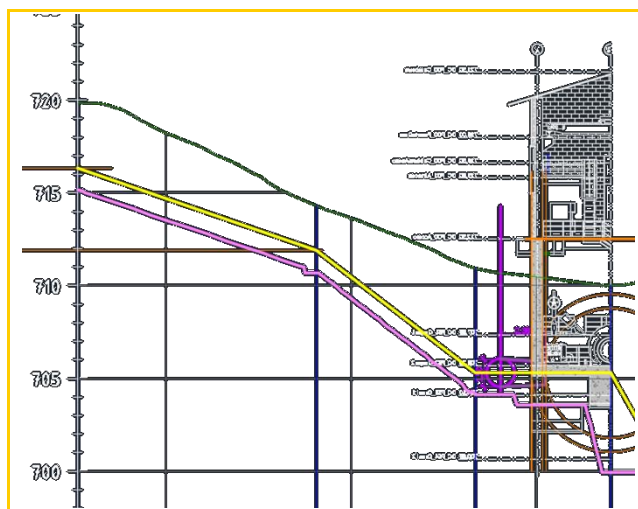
Detalle de la entrada de la Tubería Forzada a las turbinas de la Casa de Máquinas, con una excavación de unos 7 m en roca del Tipo II. Cota excavación en color violeta.
